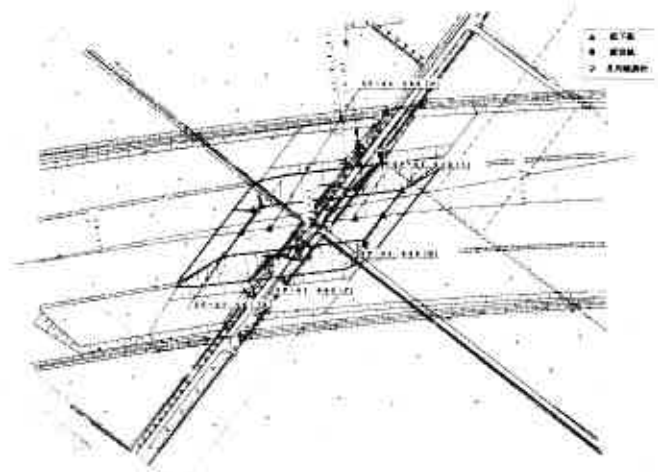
美原試験施工の断面図と測定計器の配置 (文献3)に加筆修正)
